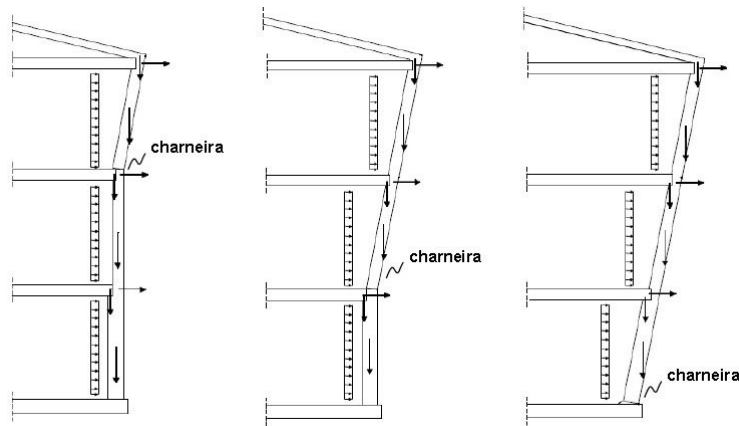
Mecanismo de colapso das fachadas fora-do-plano, por quebra de ligações [33]
